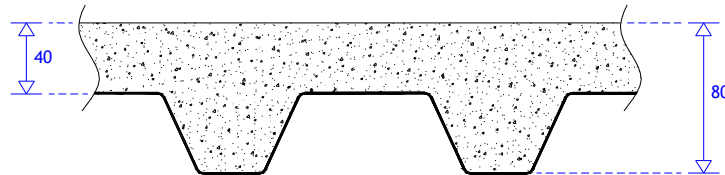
Espessuras mínimas [mm] da secção transversal de uma laje mista sem funções de contraventamento.
